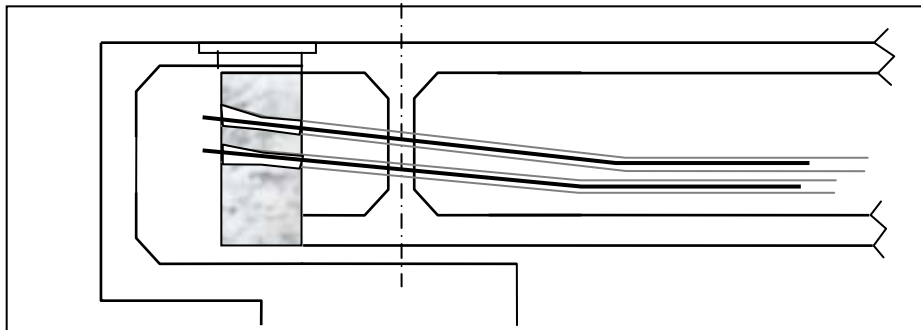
Poutre rapportée en extrémité d'ouvrage
